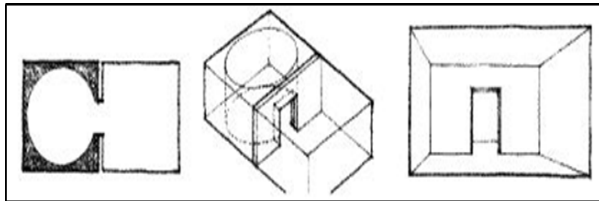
Ruang yang berkaitan secara seimbang
